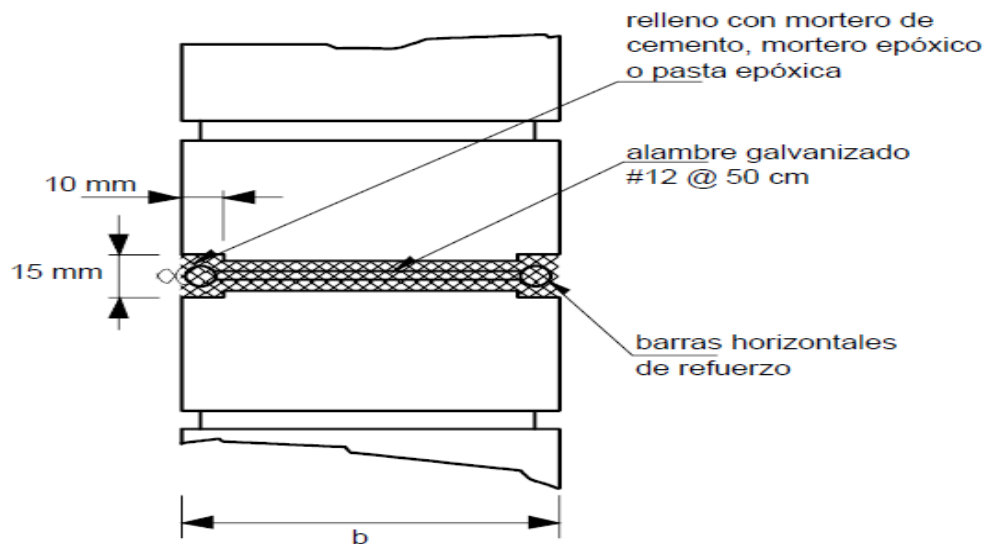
Detalle de inserción de varillas de acero en las juntas de un muro de ladrillo. Fuente: ALCOCER, S. Rehabilitación de estructuras de mampostería. [aut. libro] Fundación ICA. *Edificaciones de mampostería para vivienda*. s.l.: El autor, 1999, págs. 457-560.
